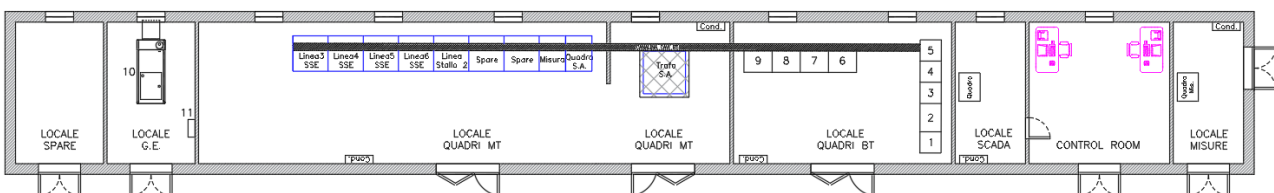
Stazione Elettrica Utente Stallo 2 – Planimetria
